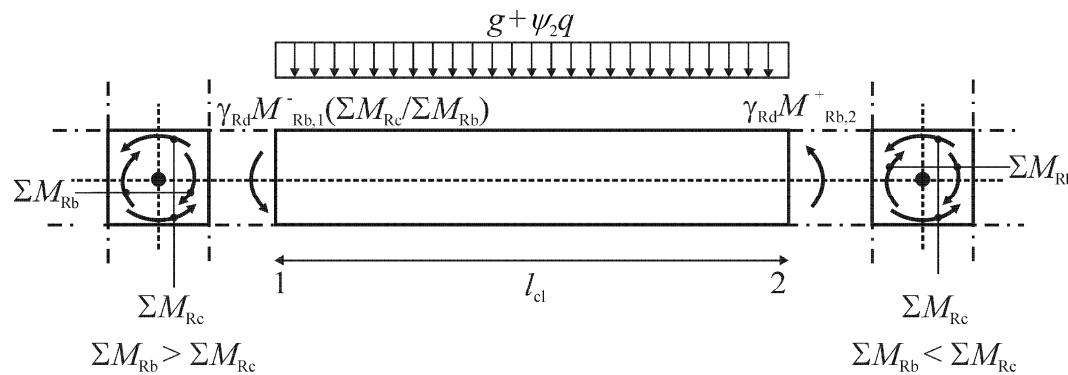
Kapazitätsbemessungswerte der Querkräfte in Balken
